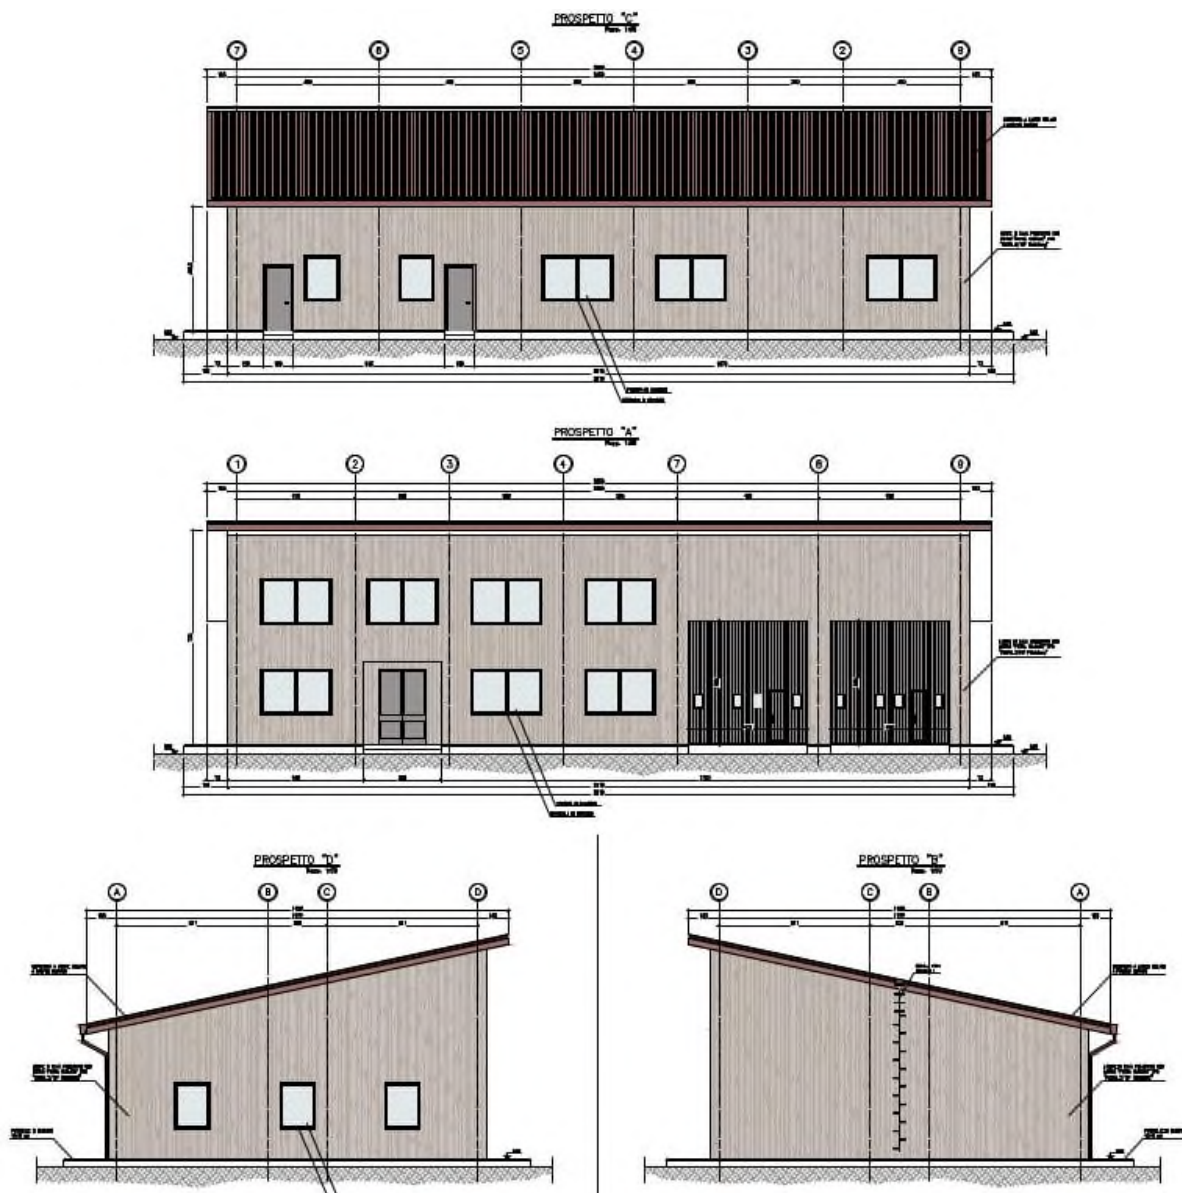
Fabbricato posto neve - Pianta e Prospetti
